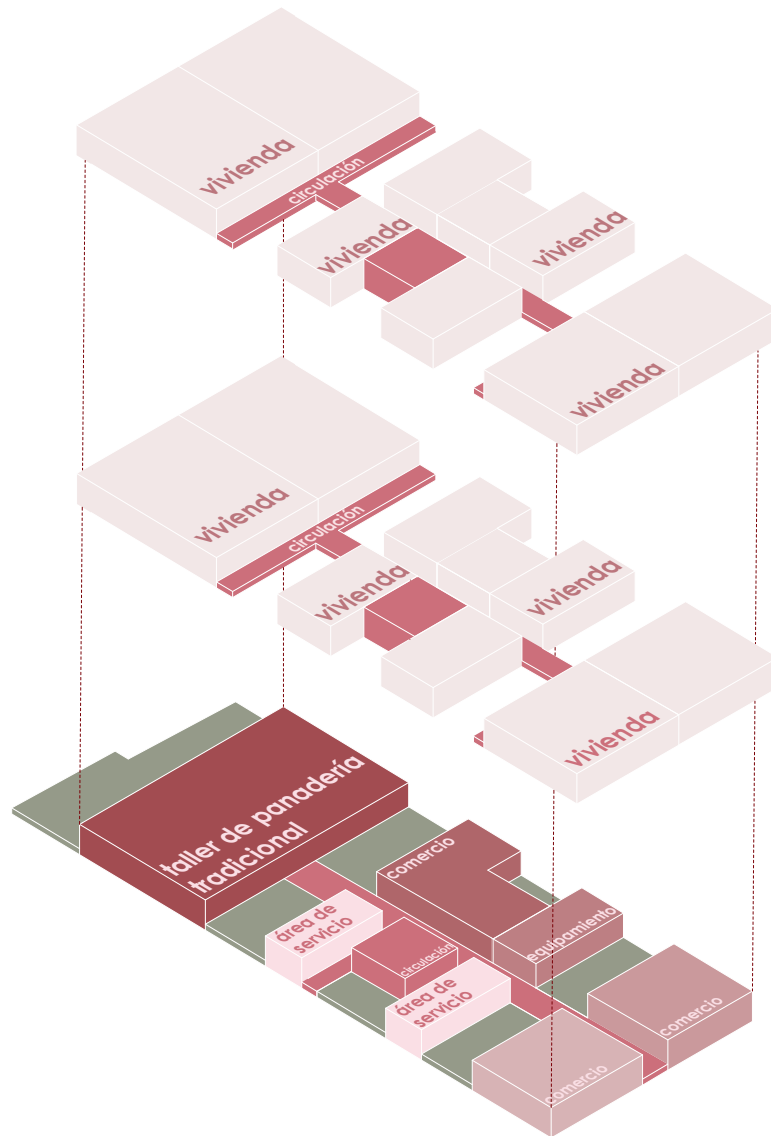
Axonetría de la propuesta arquitectónica con tablas de áreas. Nota. Elaboración propia.
